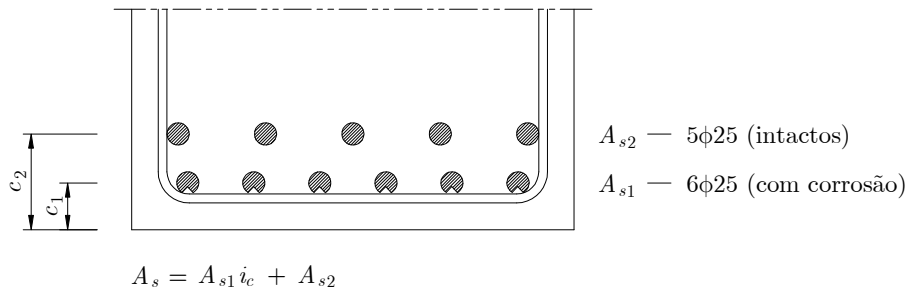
Armaduras da secção de meio vão do tramo central (viga 1).
